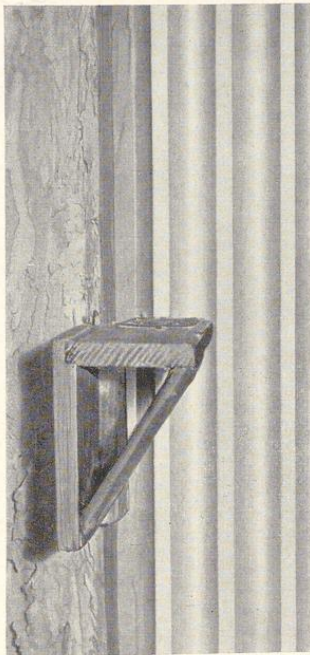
Schablone zum Ziehen der Stege an geschwelter Säule
